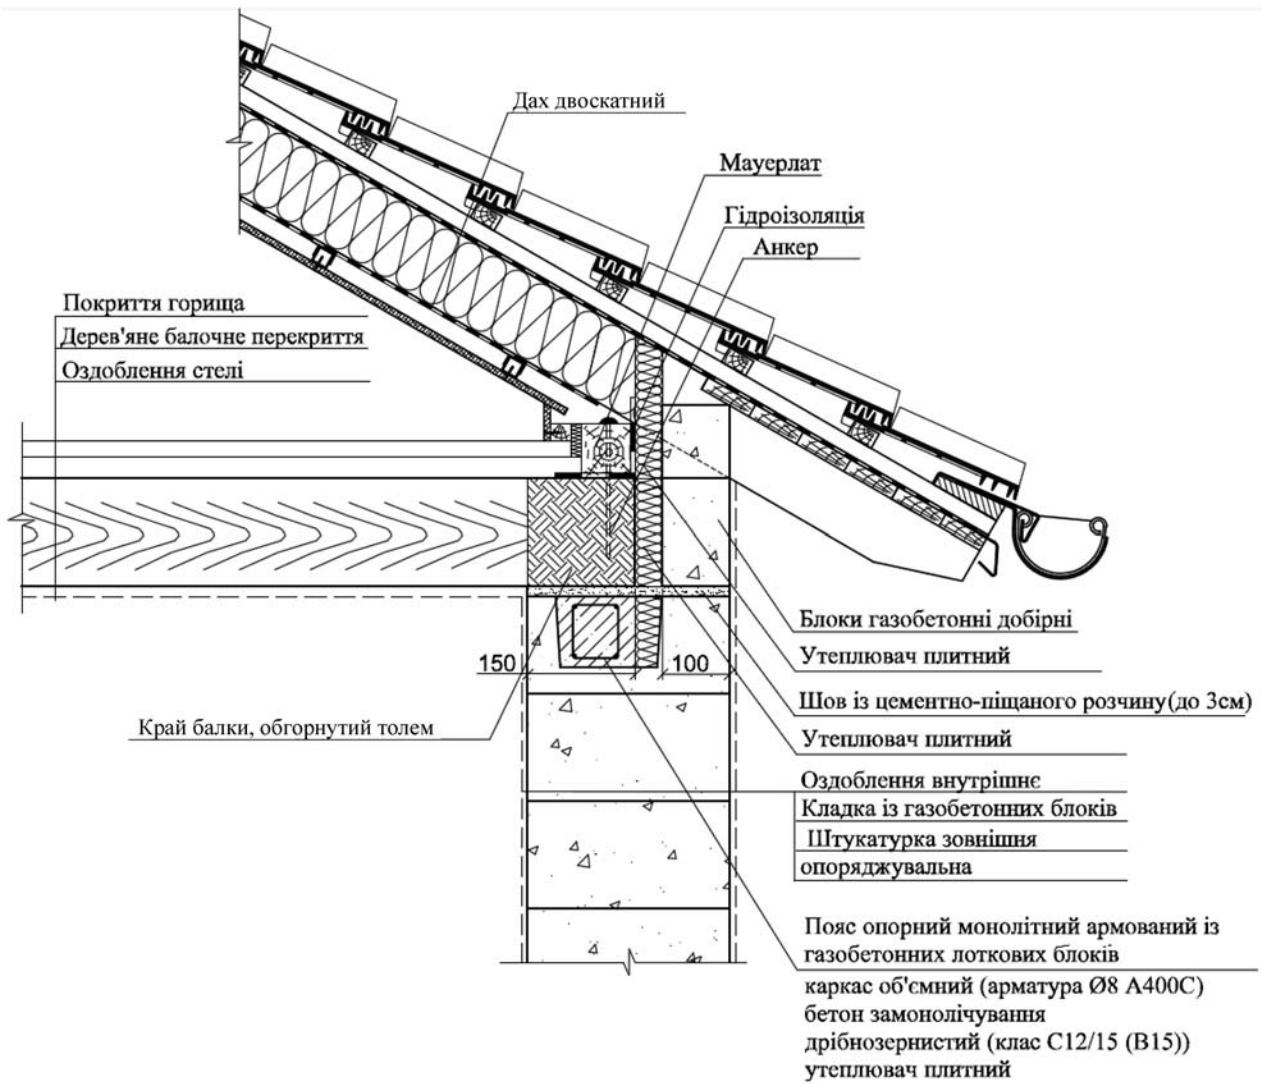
Вузол обпирання даху із дерев'яних конструкцій на газобетонні стіни на рівні горищного перекриття на газобетонні стіни
